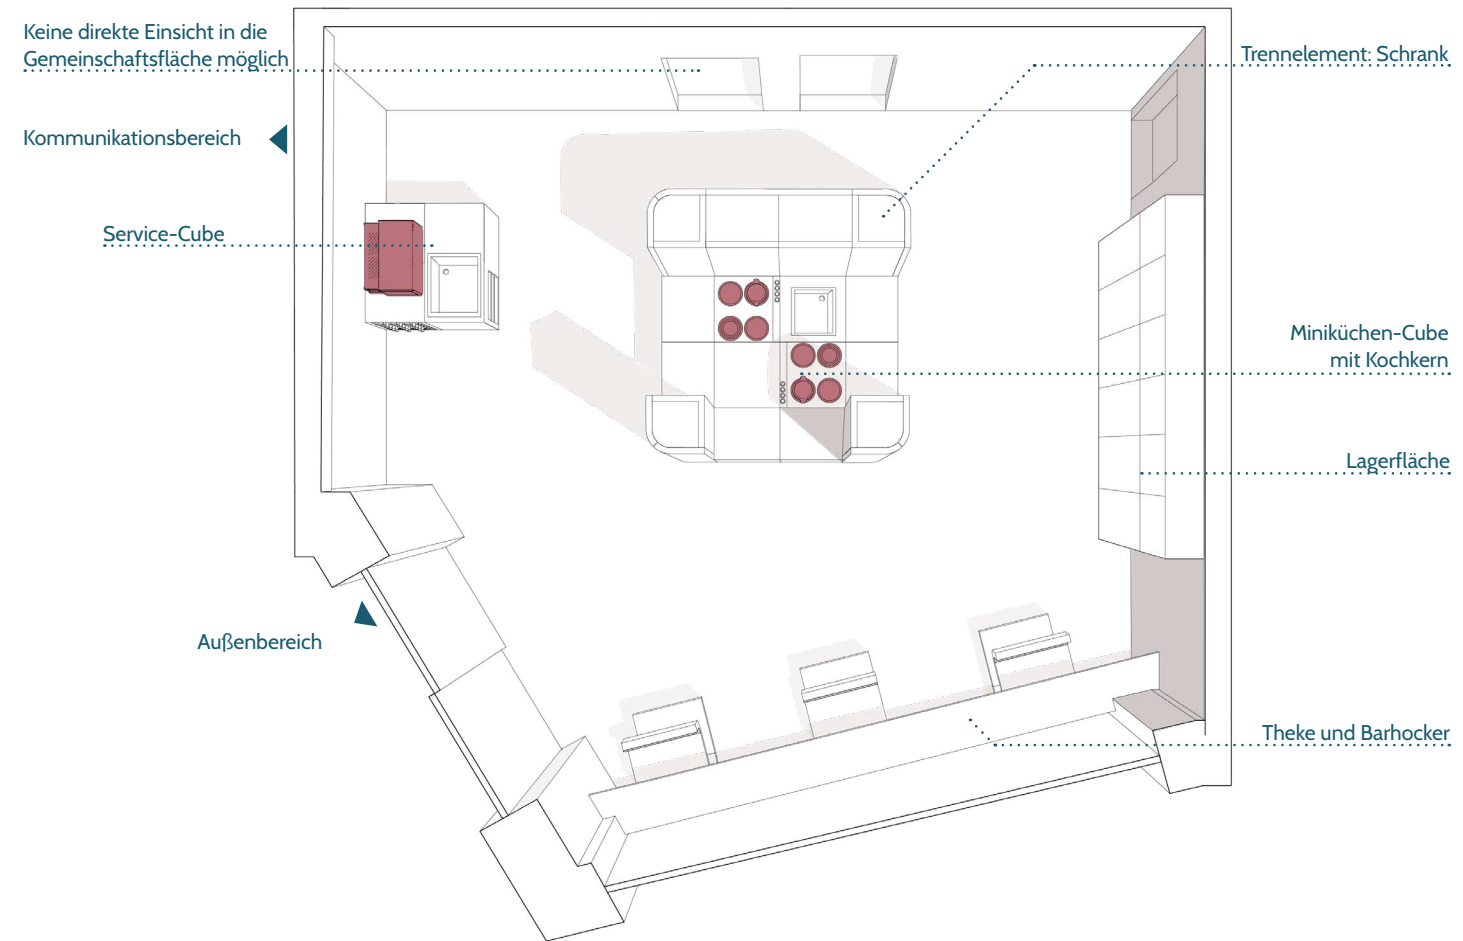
Grundriss - Koch- und Essbereich
